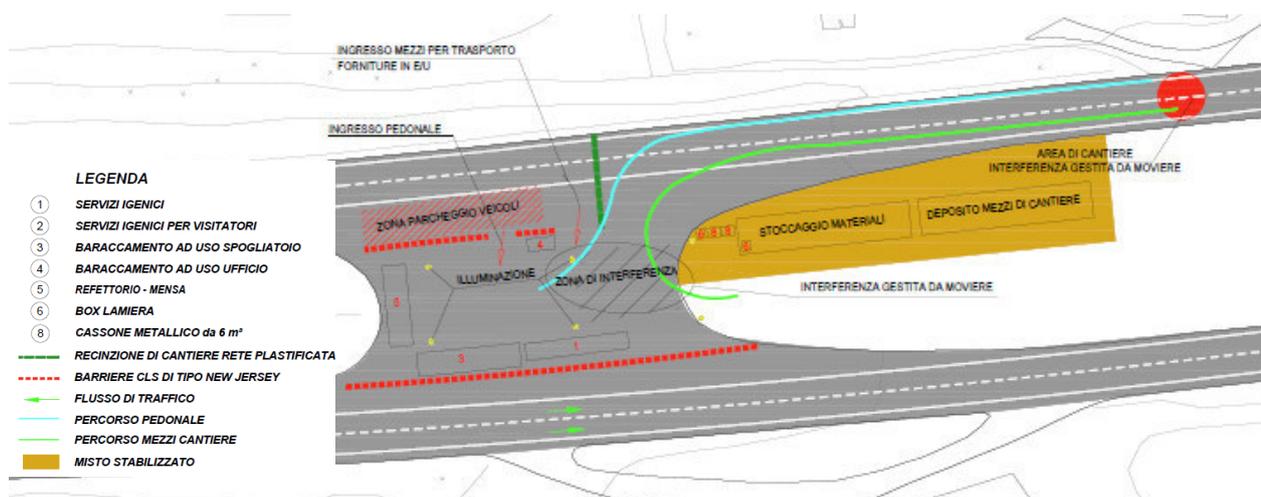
Layout di cantiere – galleria Gran Sasso, canna sx direzione Roma
